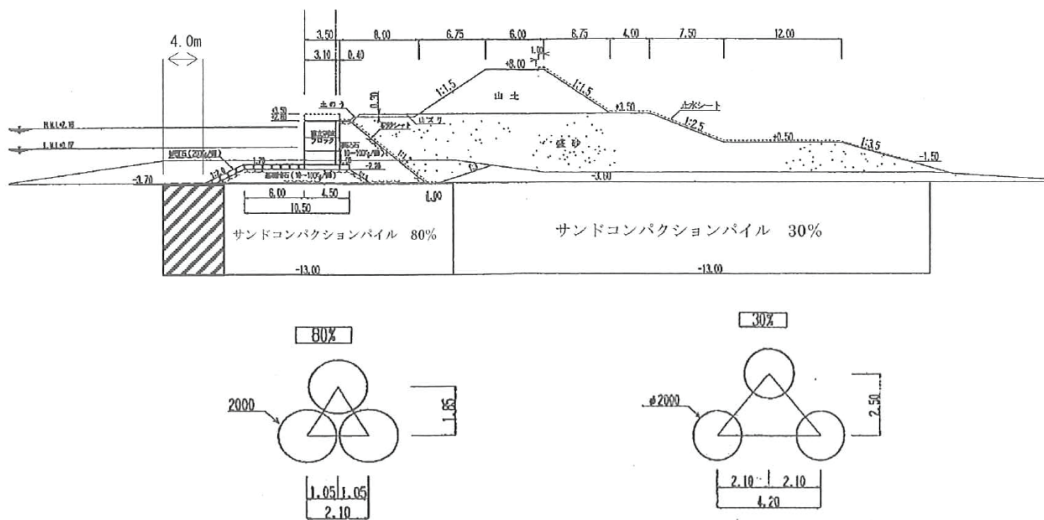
試験施工断面図および杭配置（高置換部，低置換部）¹⁹⁾
